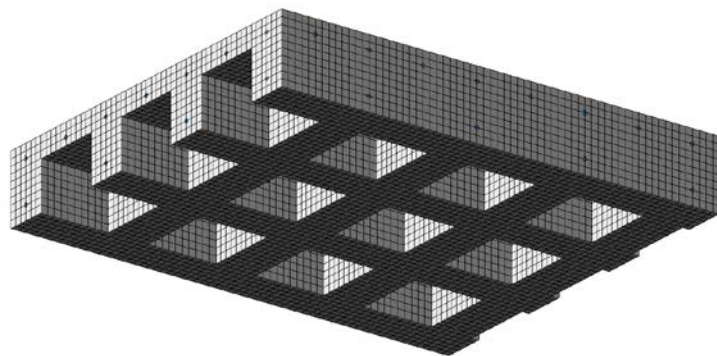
Пространственная модель плиты перекрытия с прямоугольными вкладышами пустотообразователями
